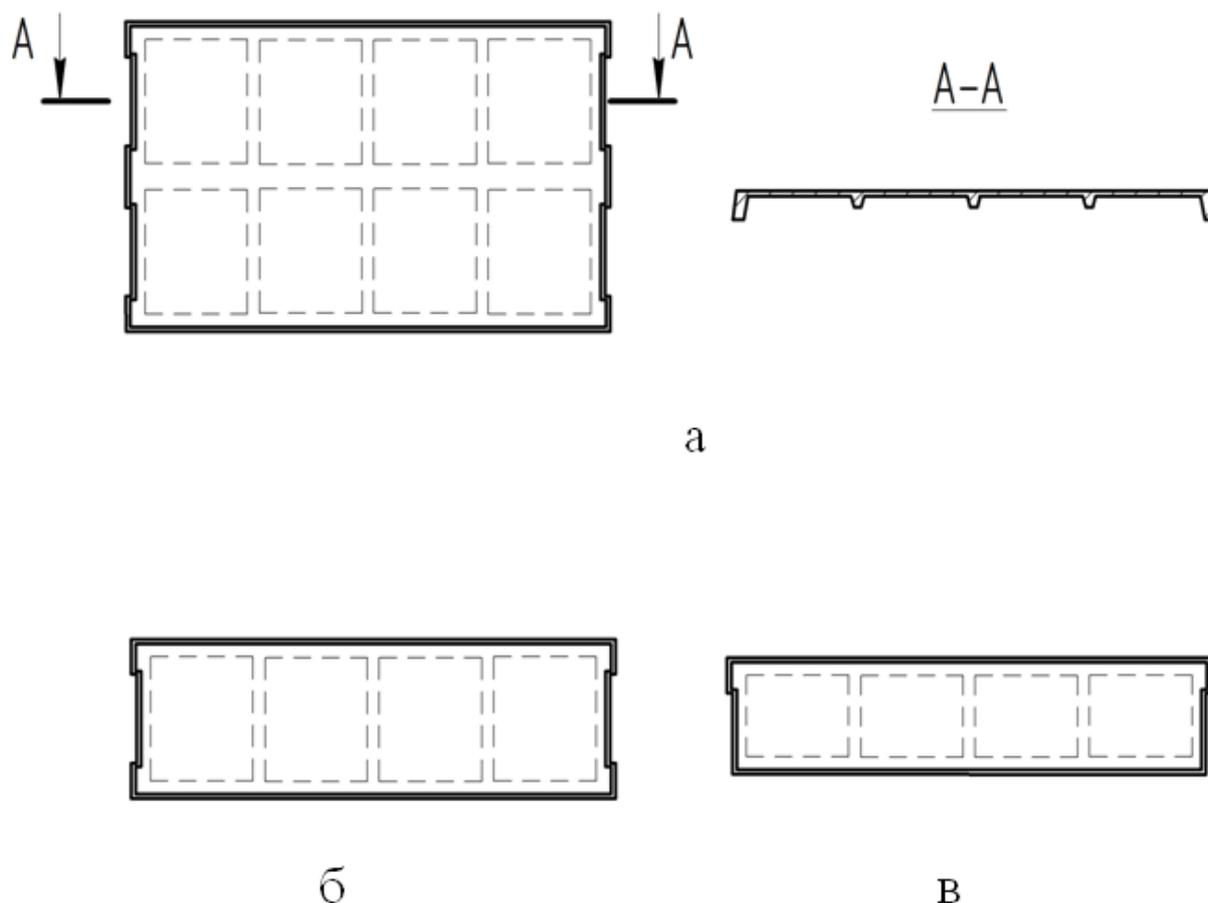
Железобетонные ребристые плиты перекрытий:
